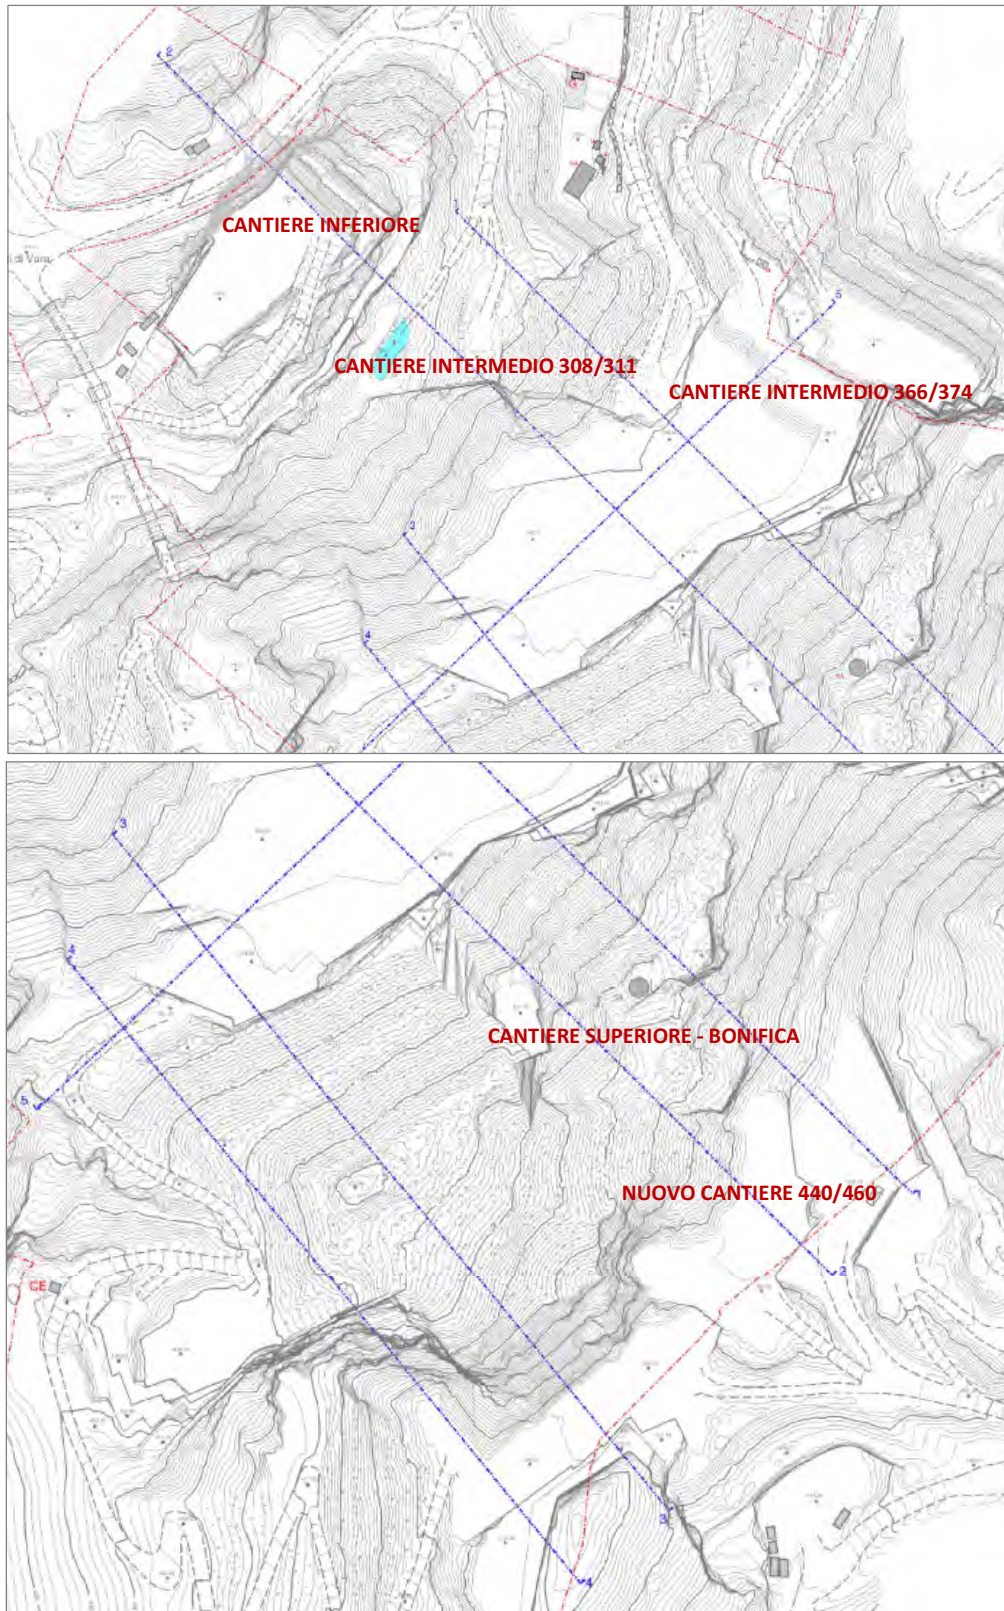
Planimetria di massima con la collocazione dei cantieri nell'attività estrattiva (Tav. 3 bis Piano 2019).
